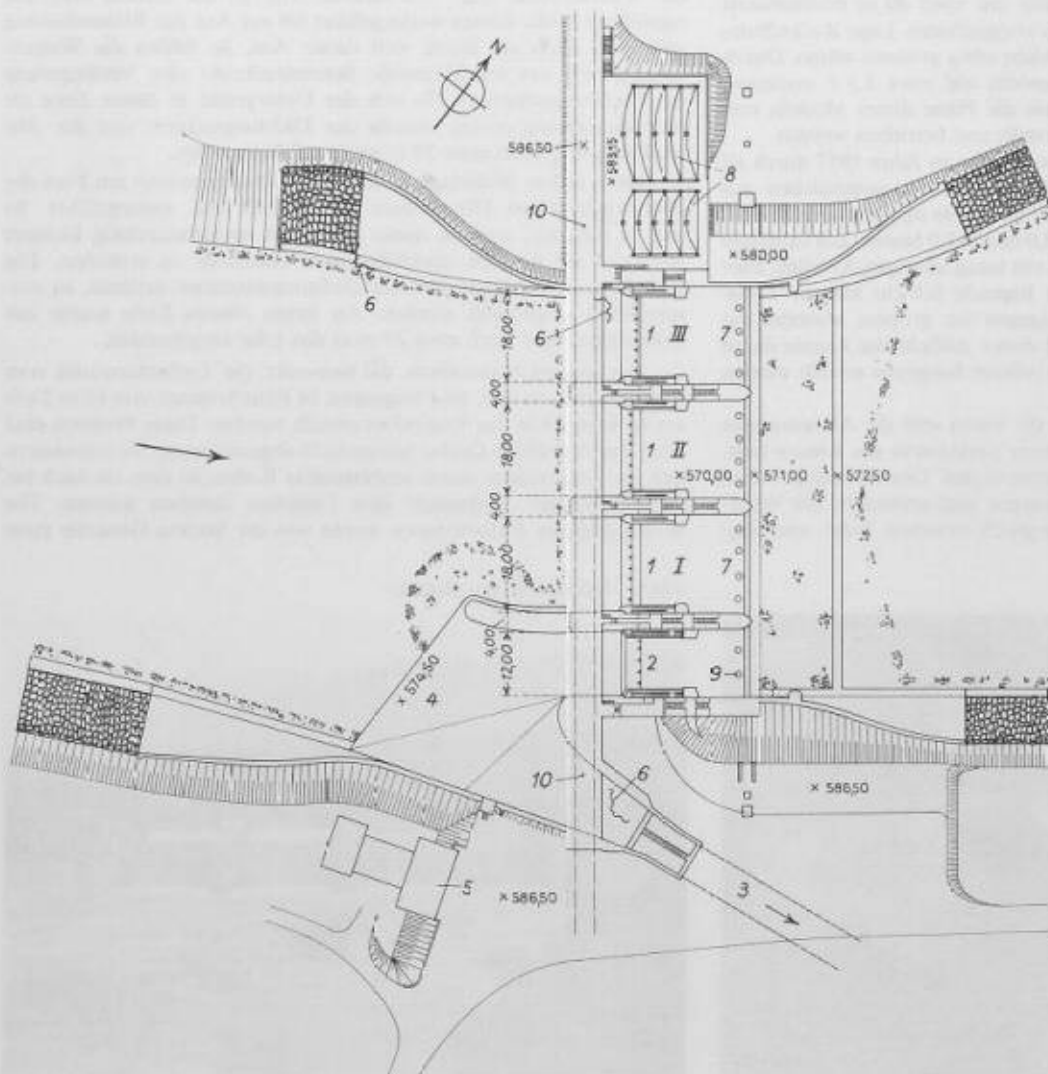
Grundriss der Wehranlage, 1:1500
